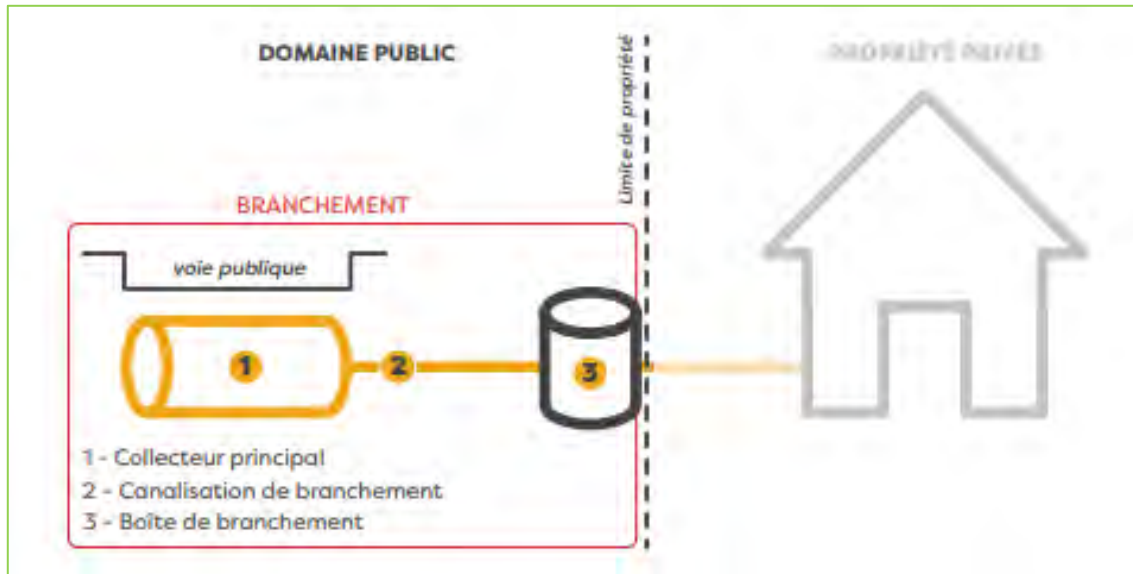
SCHEMA D'UN BRANCHEMENT EAUX USEES (SOURCE : REGLEMENT DE SERVICE - ASSAINISSEMENT COLLECTIF - METROPOLE ROUEN NORMANDIE)
